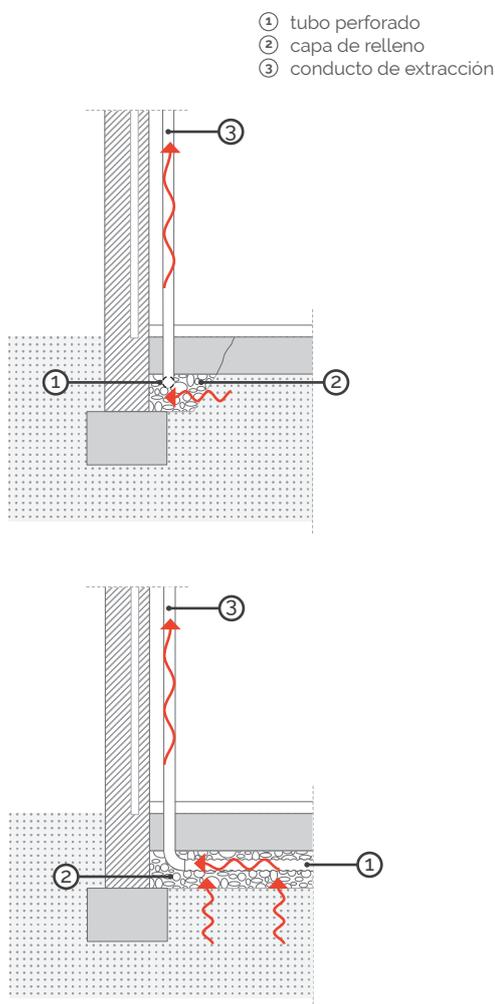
Tubo perforado instalado mediante excavación. Sección transversal (arriba) y sección longitudinal (abajo)
